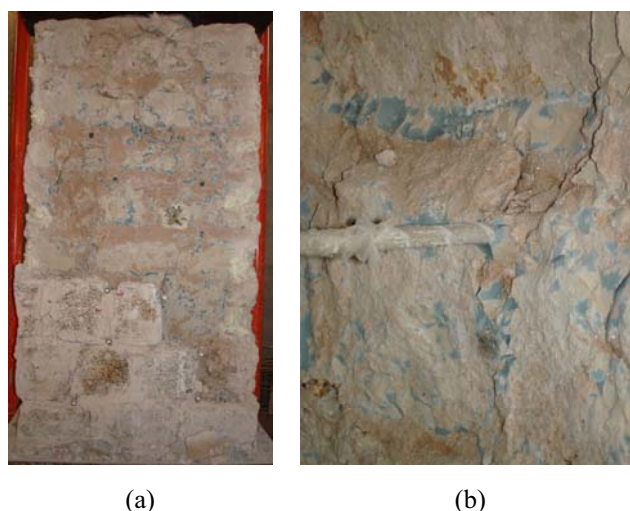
Pano interno da parede 3W4: (a) vista geral; (b) pormenor da ligação da pregagem ao pano interno.
